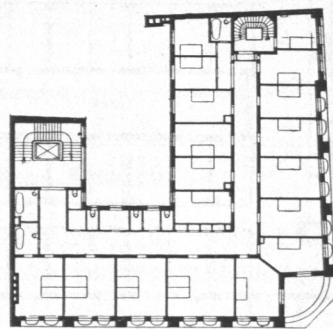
Rathaus-Hotel, Obergeschoß, Grundriß.
